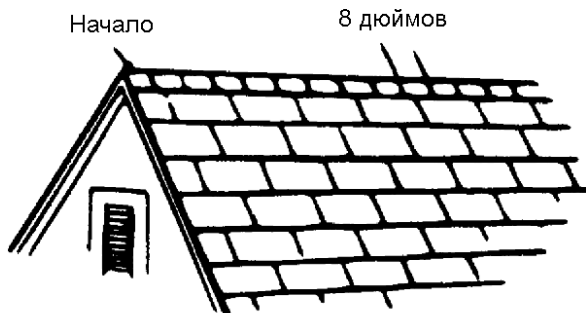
Продолжение укладки плиточных листов Ridglass с открытой частью 9 дюймов. Все гвозди должны быть накрыты следующим листом не менее чем на 1 дюйм (Ridglass)
